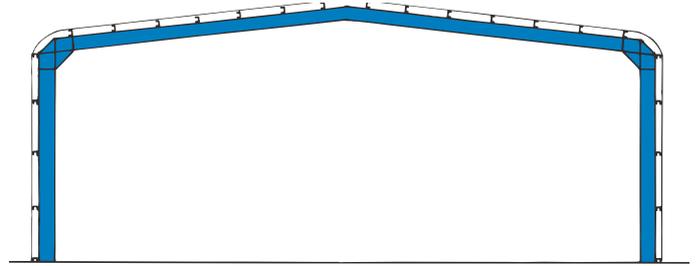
b: Zweigelenrahmen aus Vollwandprofilen, Spannweite 18,00 m, Lagerhalle
